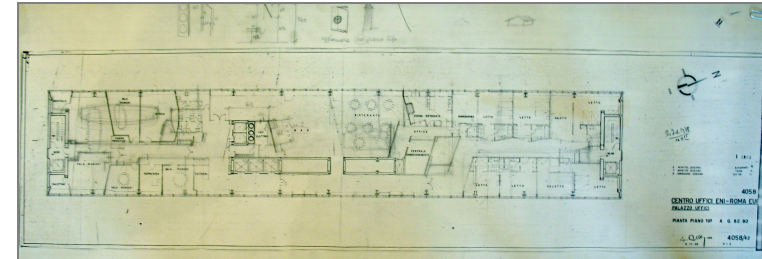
pianta piano 19° - primo progetto (fonte CSAC , tav. 4058/42, archivio n.
